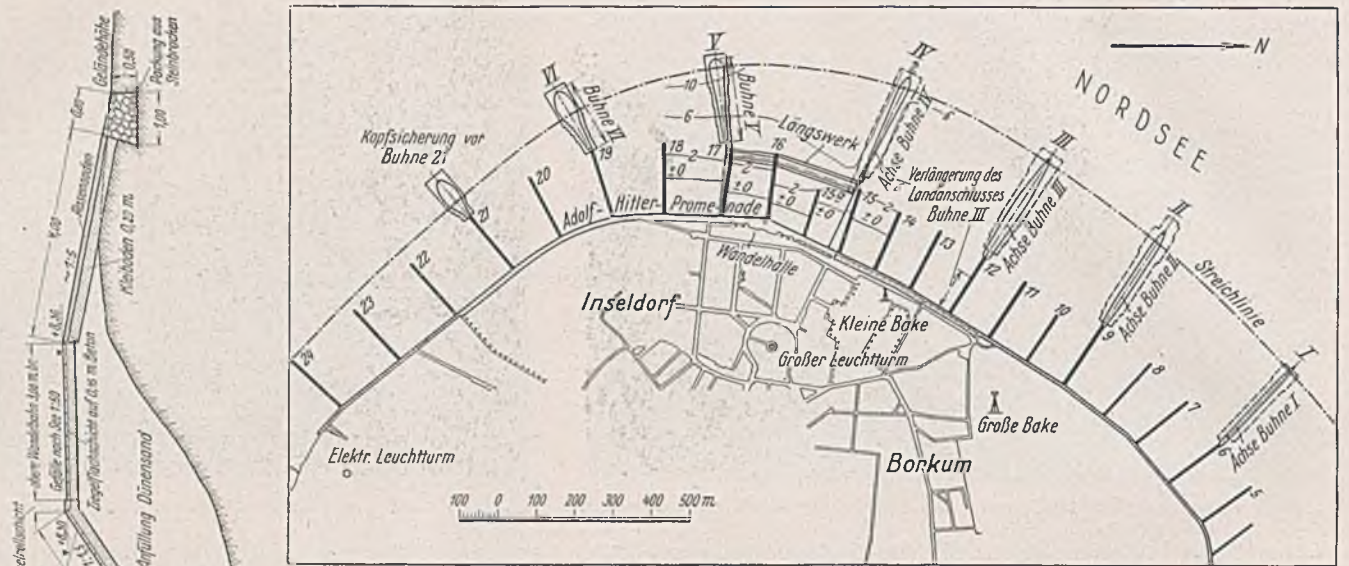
Lageplan der Strandschutzbauten auf Borkum.
